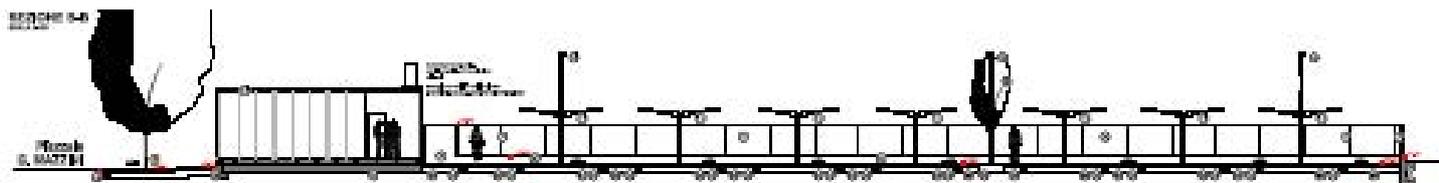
Treviglio Ovest: layout ciclostazione prossima realizzazione.
